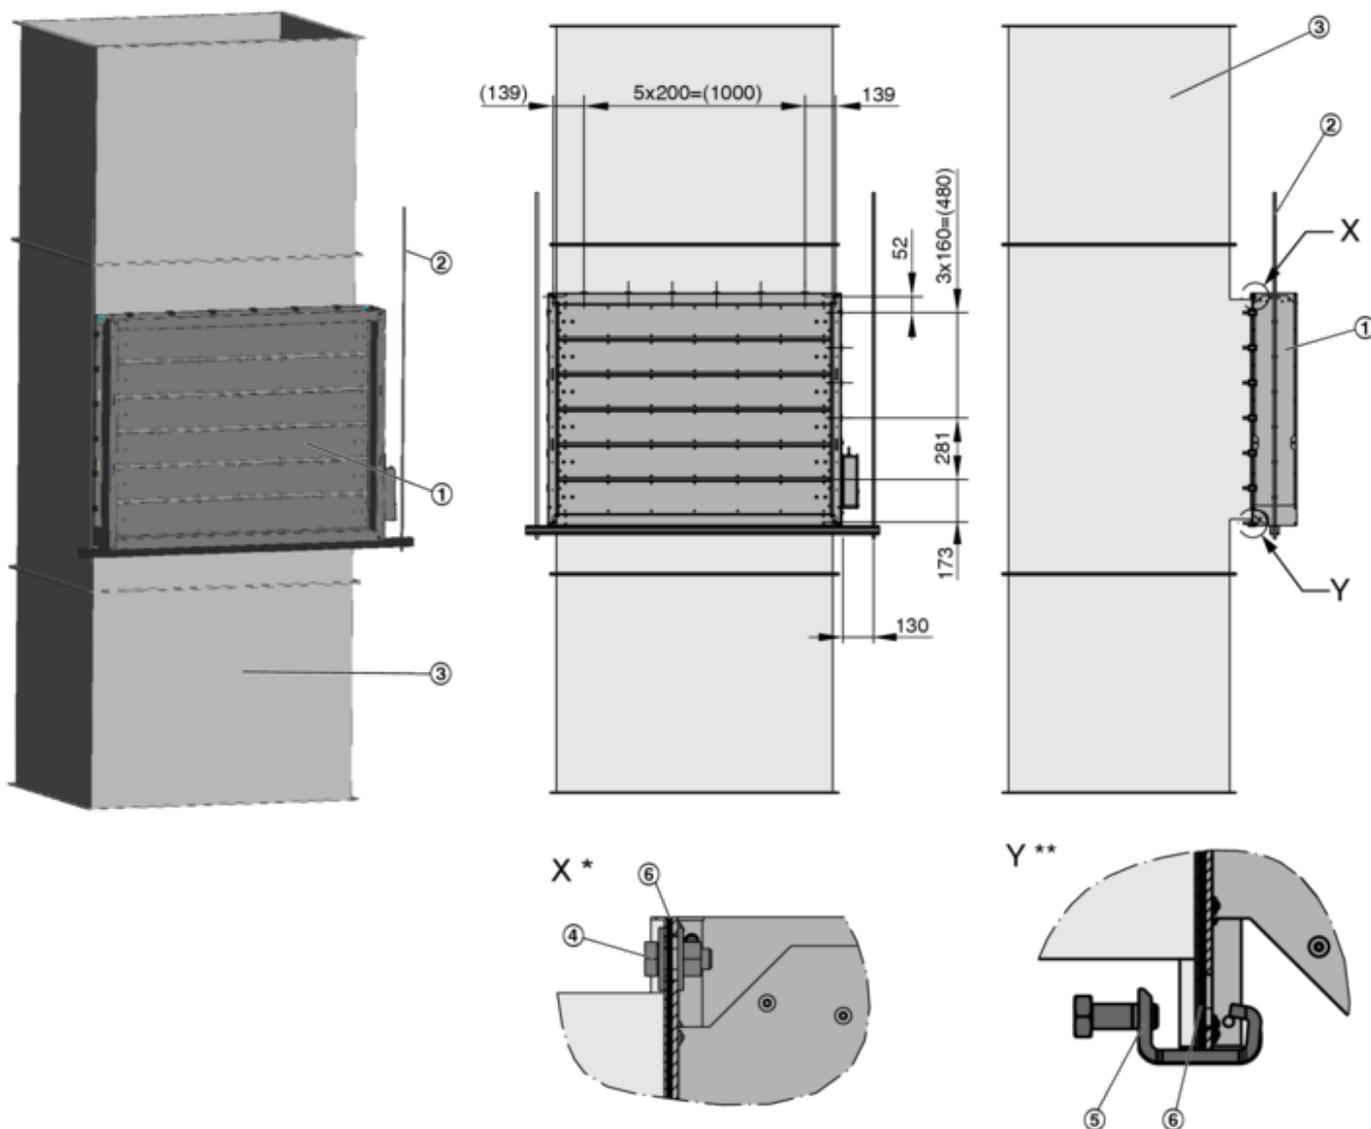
Einbau an einer vertikalen Entrauchungsleitung
